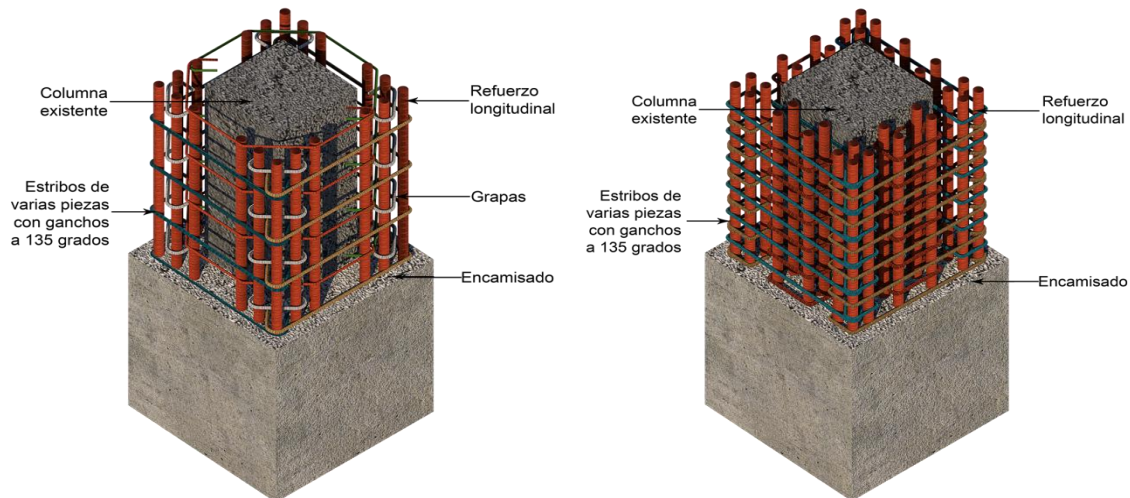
Perspectiva de columnas encamisadas según las configuraciones
